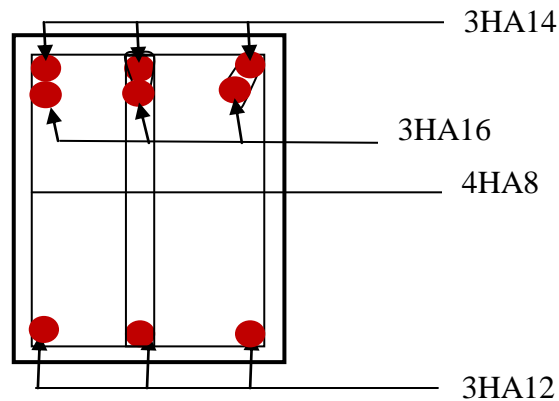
Ferrailage aux appuis d'une poutre principale.
